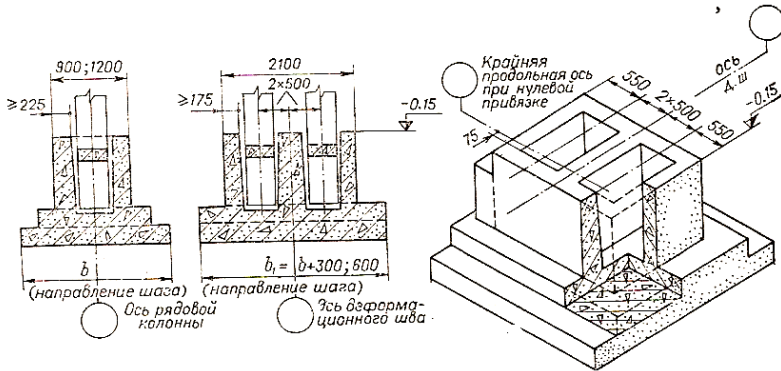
Монолитные фундаменты железобетонных колонн в местах устройства деформационных швов
